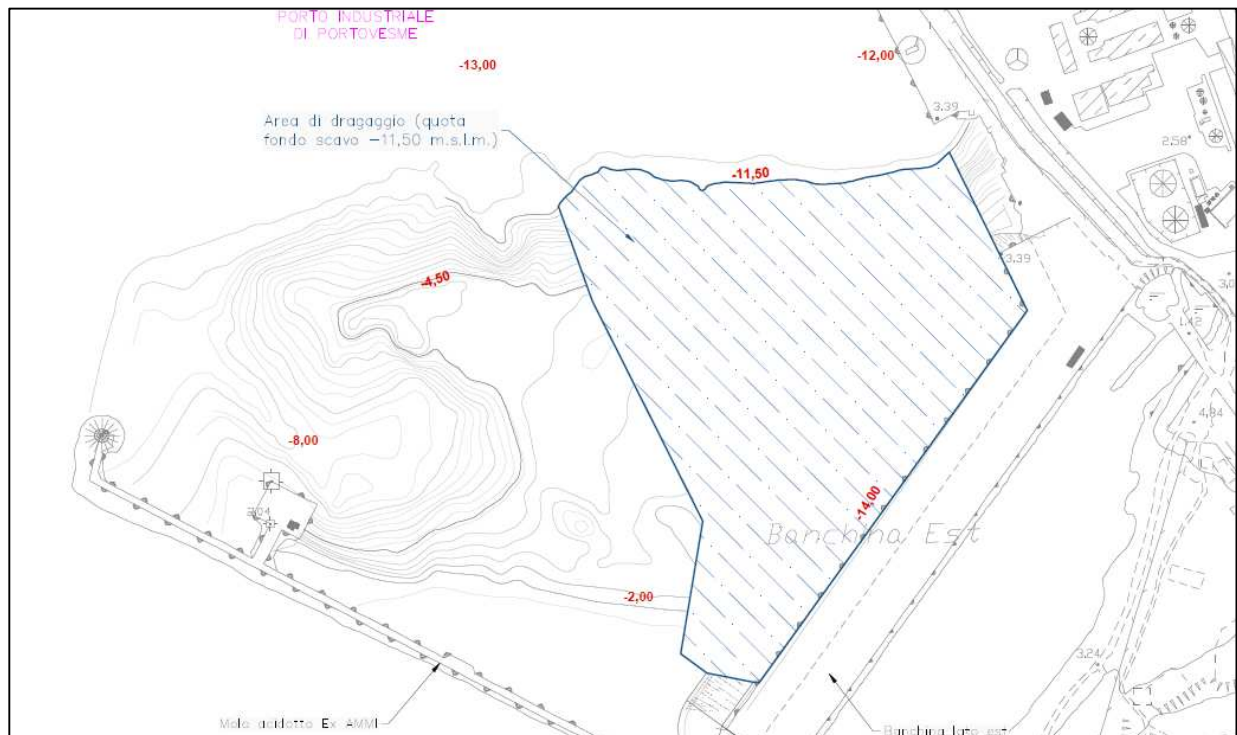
Planimetria generale area di dragaggio- Stato di progetto
